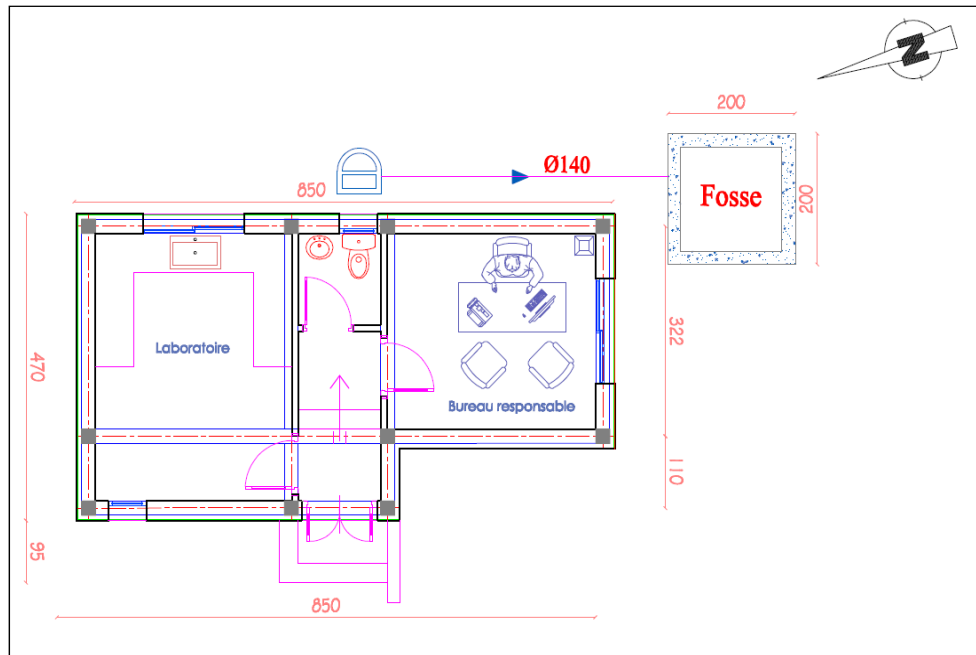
LE PLAN ARCHITECTURE DU LABORATOIRE
